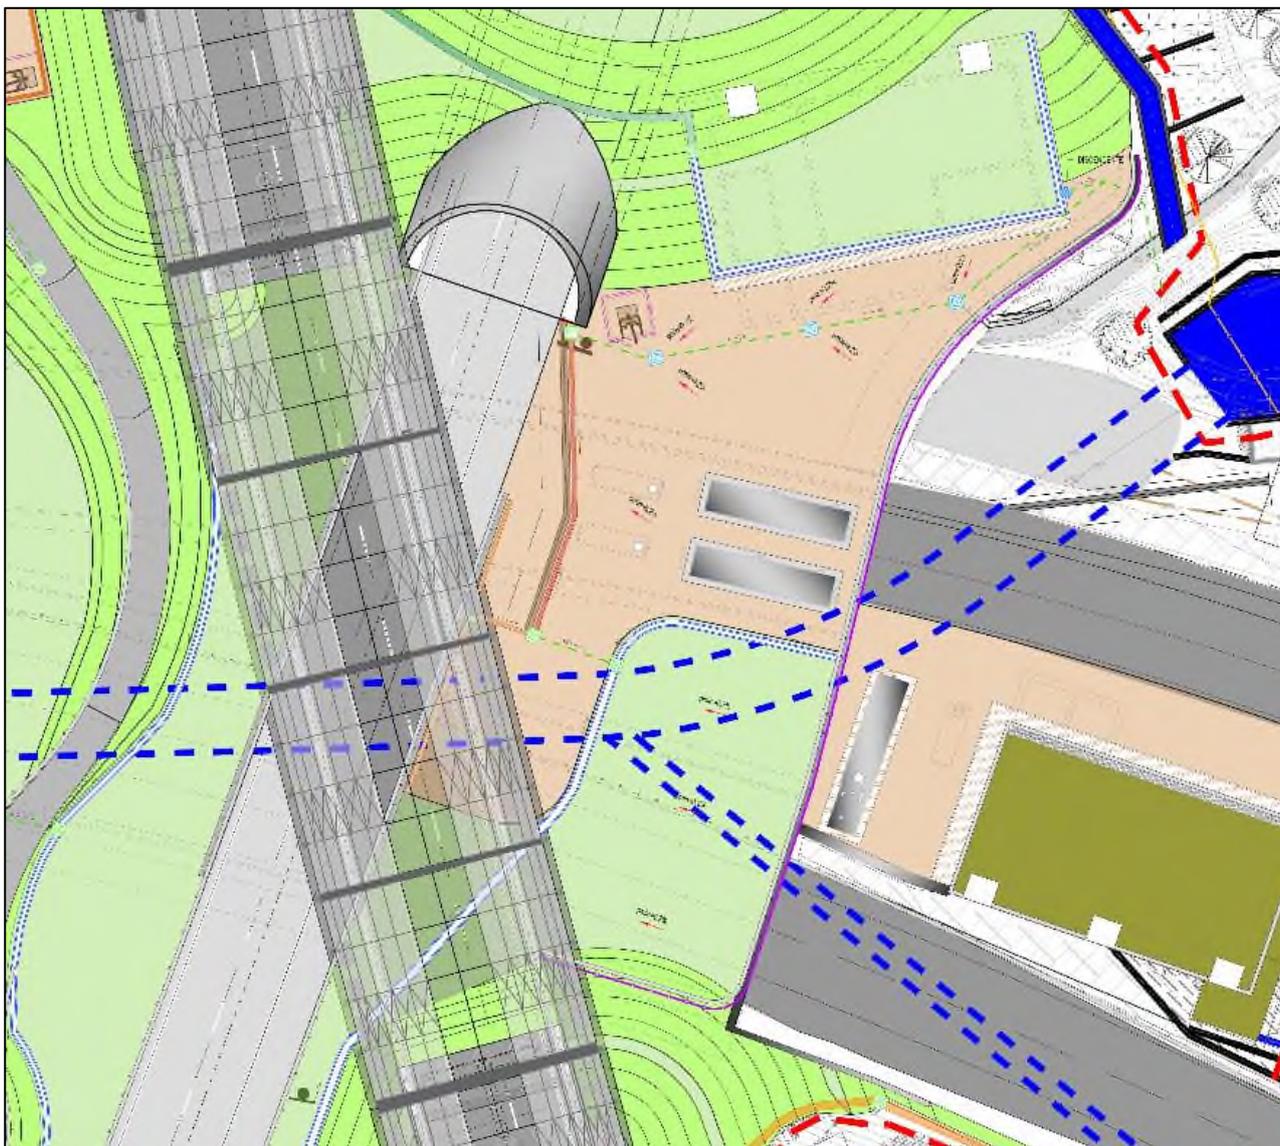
Planimetria finale dell'area d'imbocco (fonte: elaborato 110721-LL03-PE-A2-G11-GF11S-SSF00-D-AUA0521-2)
